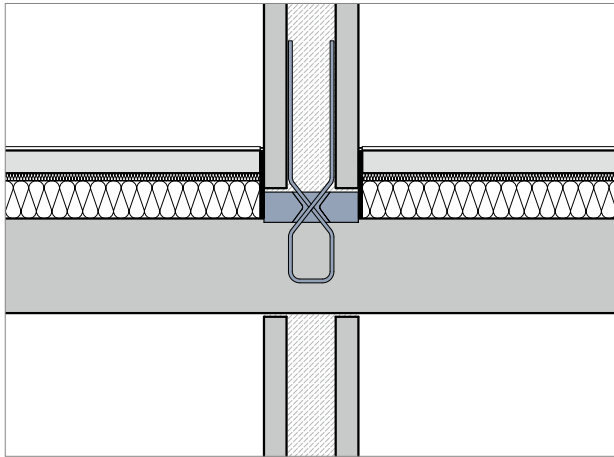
Schematische Darstellung Schöck Sconnex® Typ W bei Doppelwänden und Aufdeckendämmung
